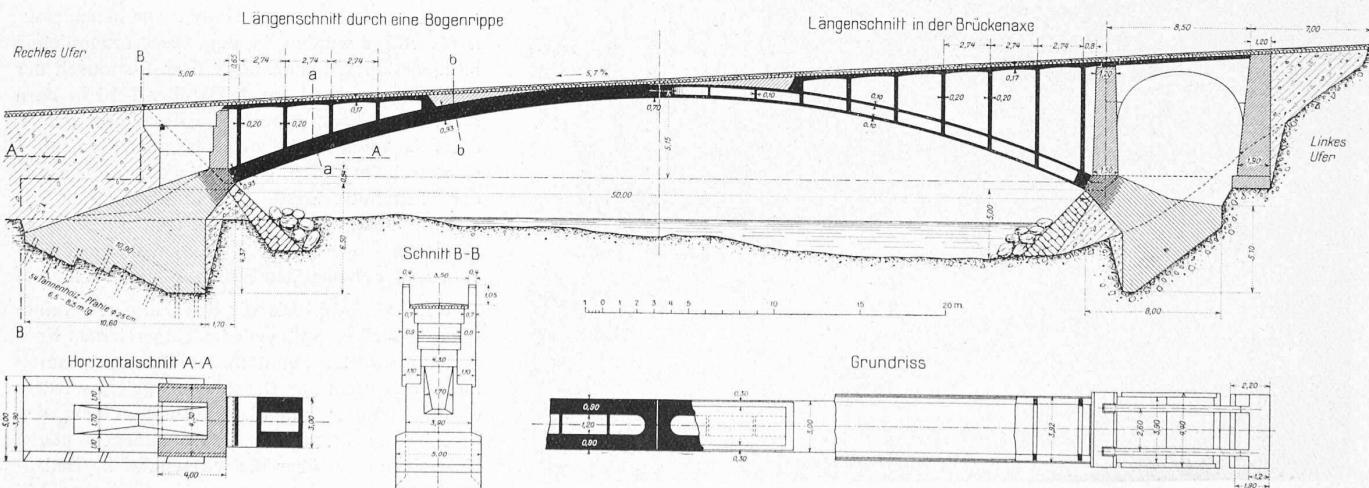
Rheinbrücke bei Waltensburg, erbaut 1912 durch Westermann &amp; Cie. A.-G., St. Gallen. — Grundriss und Schnitte 1 : 400.
